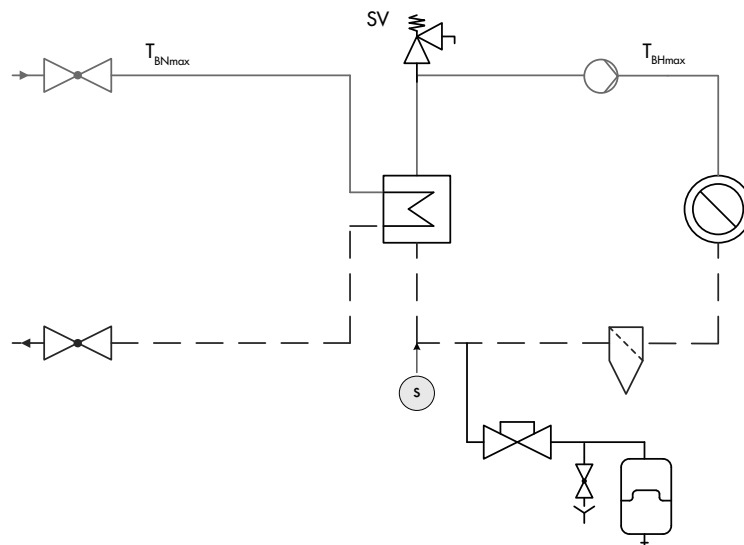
Druckhaltung mit Membran-Druckausdehnungsgefäß
